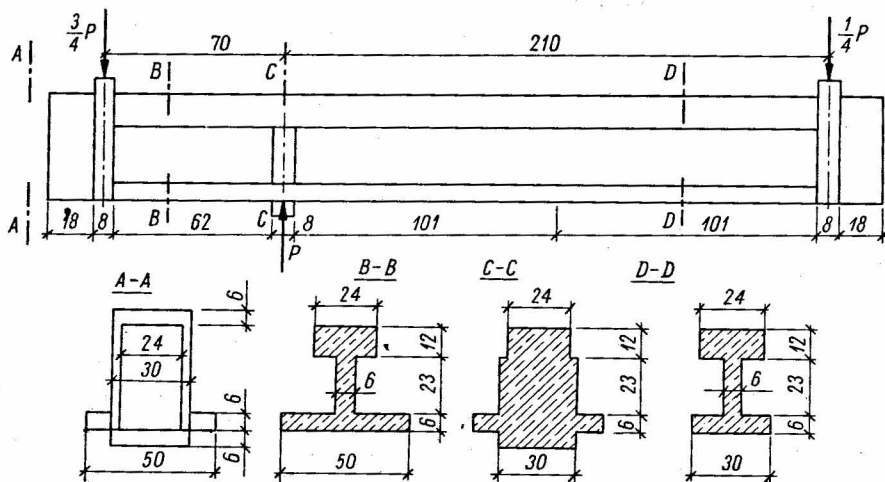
Poutres dans les essais de ROBINSON [70]
